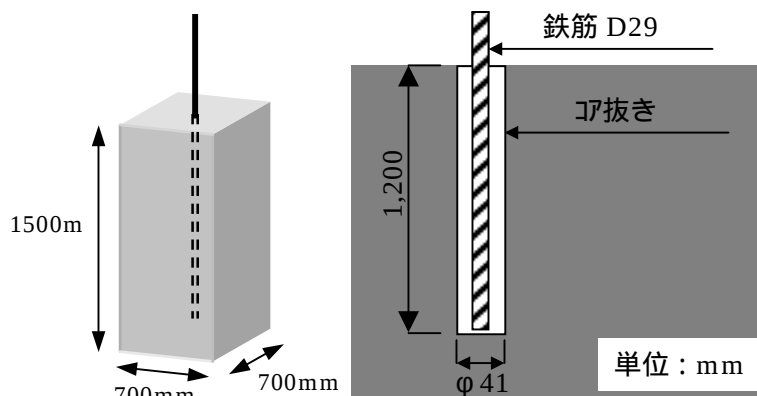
試験体形状とあと施工アンカー工法による差筋部の施工断面図
